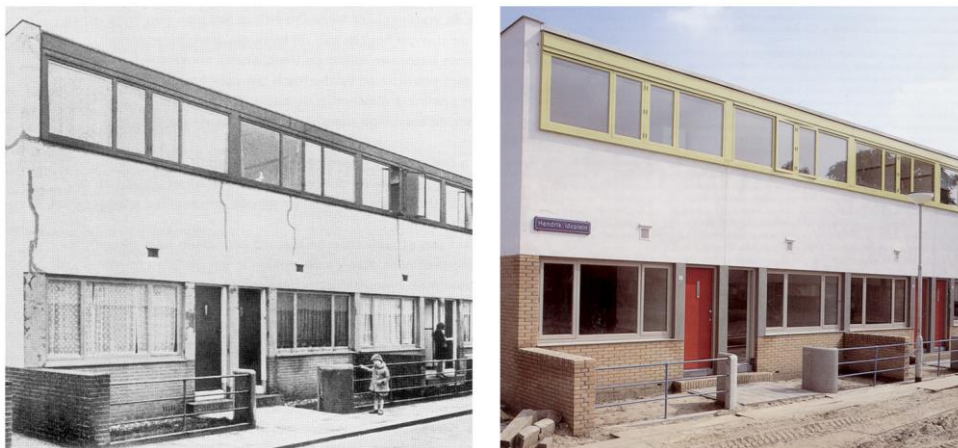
Fotografías del estado original (izquierda) y posterior a la reconstrucción (derecha) de las viviendas de uno de los bloques de Kiefhoek. Montaje de la autora.
